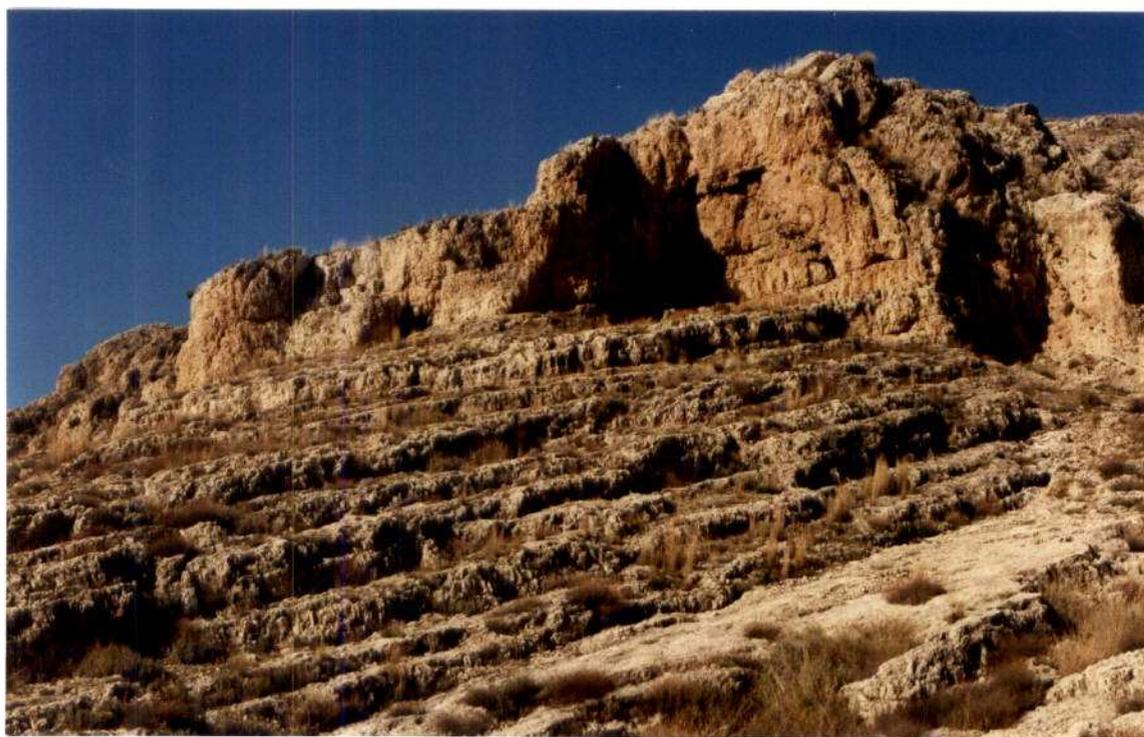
Detalle de la zona I que deberá ser recalzado con hormigón ciclópeo.
